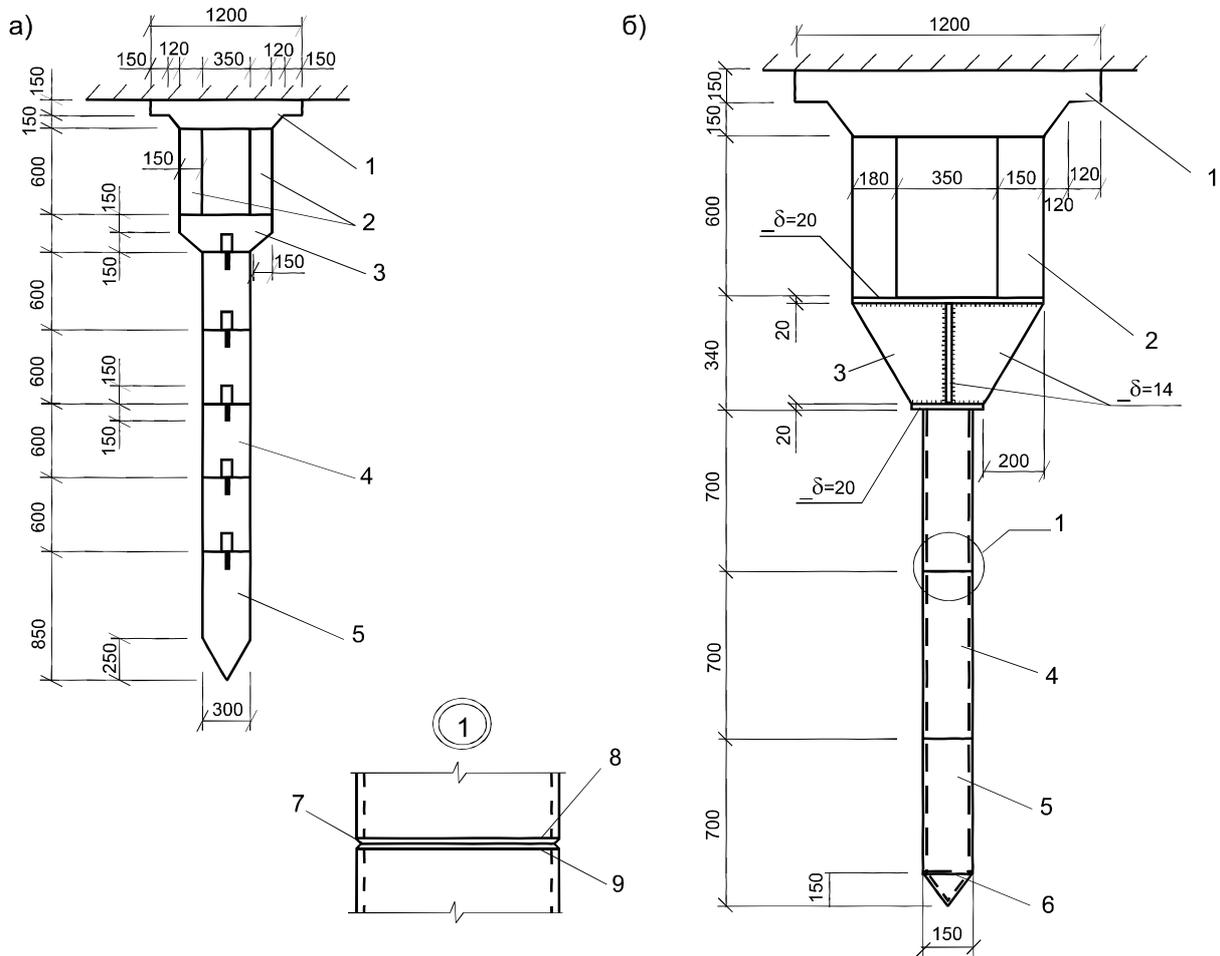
Конструкции свай «МЕГА»: а – сваи железобетонные; б – сваи из металлических труб; 1 – железобетонный распределительный элемент; 2 – подпорка; 3 – головной элемент; 4 – рядовой элемент; 5 – нижний элемент; 6 – заглушка; 7 – фрезеруемые торцы; 8 – сварка по контуру; 9 – снимаемая по контуру трубы фанера
